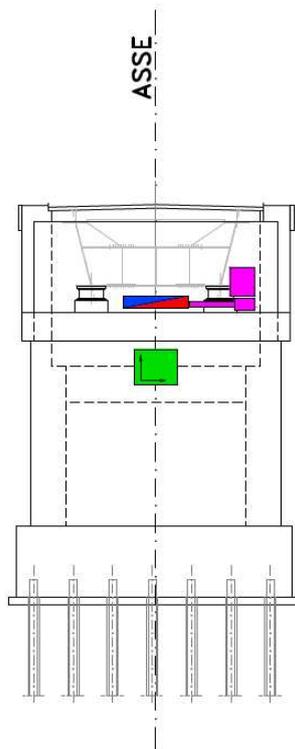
Schema posizionamento strumentazioni spalla cavalcavia
